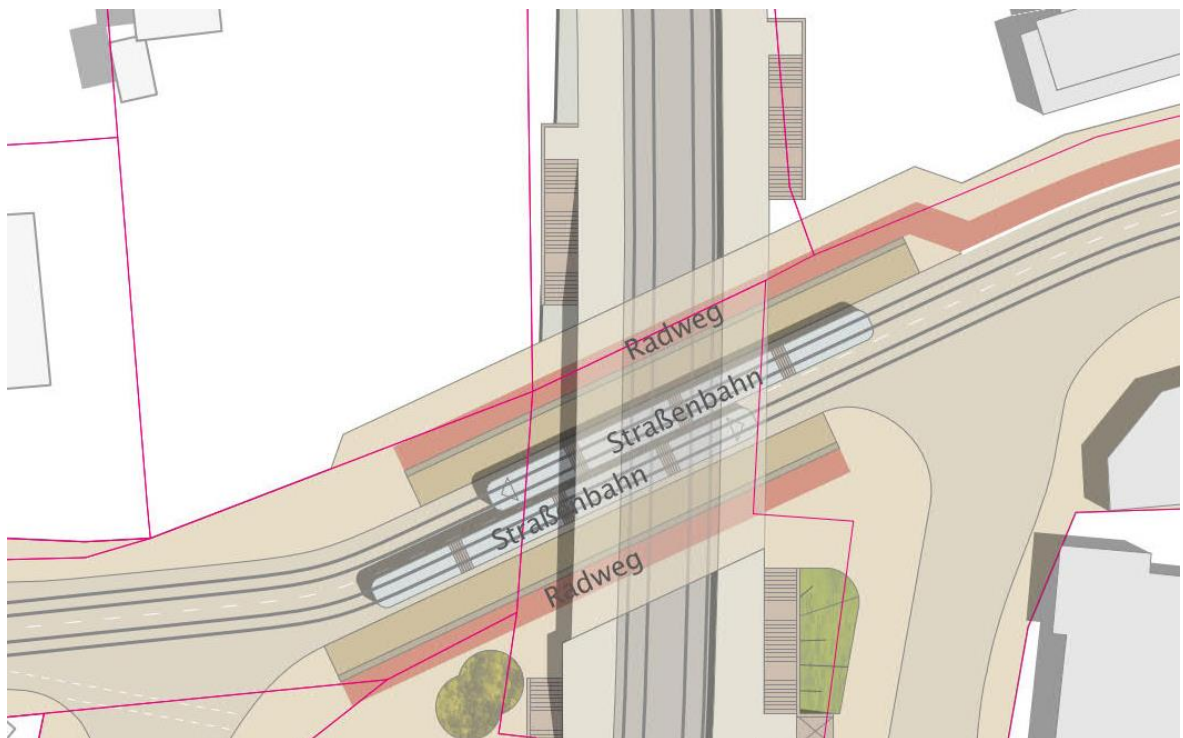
Lageplan Verkehrstrennung unter EÜ mit Bahnsteigverlängerung
